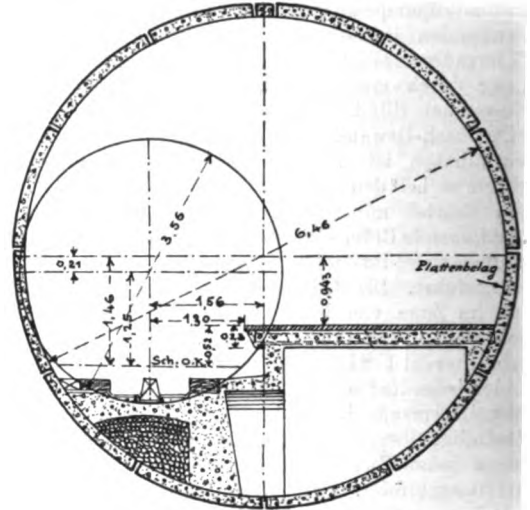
Querschnitt durch einen Tunnel der Untergrundbahn.
